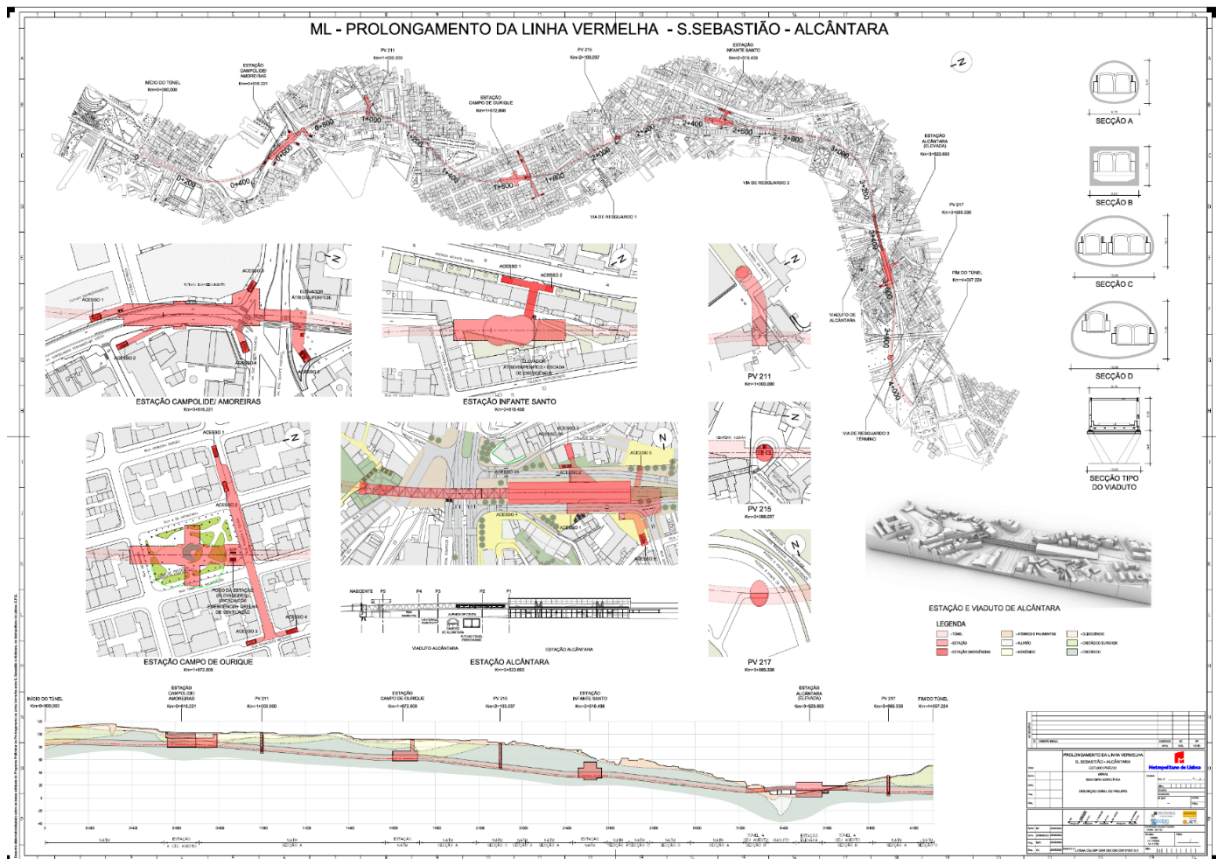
Planta de localização Geral do Projeto – LVSSA MSA PE GER 000 000 DW 010010 0
